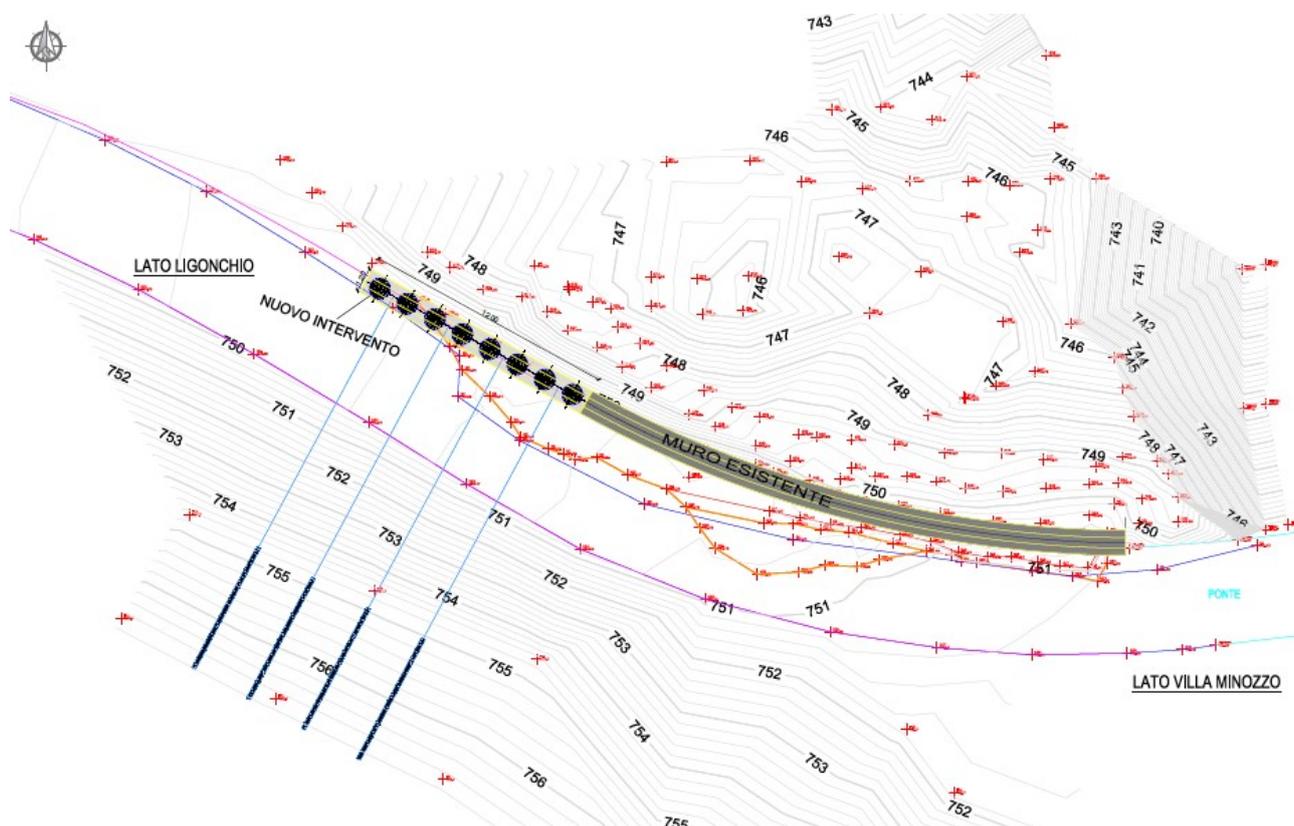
Estratto della planimetria d'intervento: nuova porzione di opera da realizzare.
